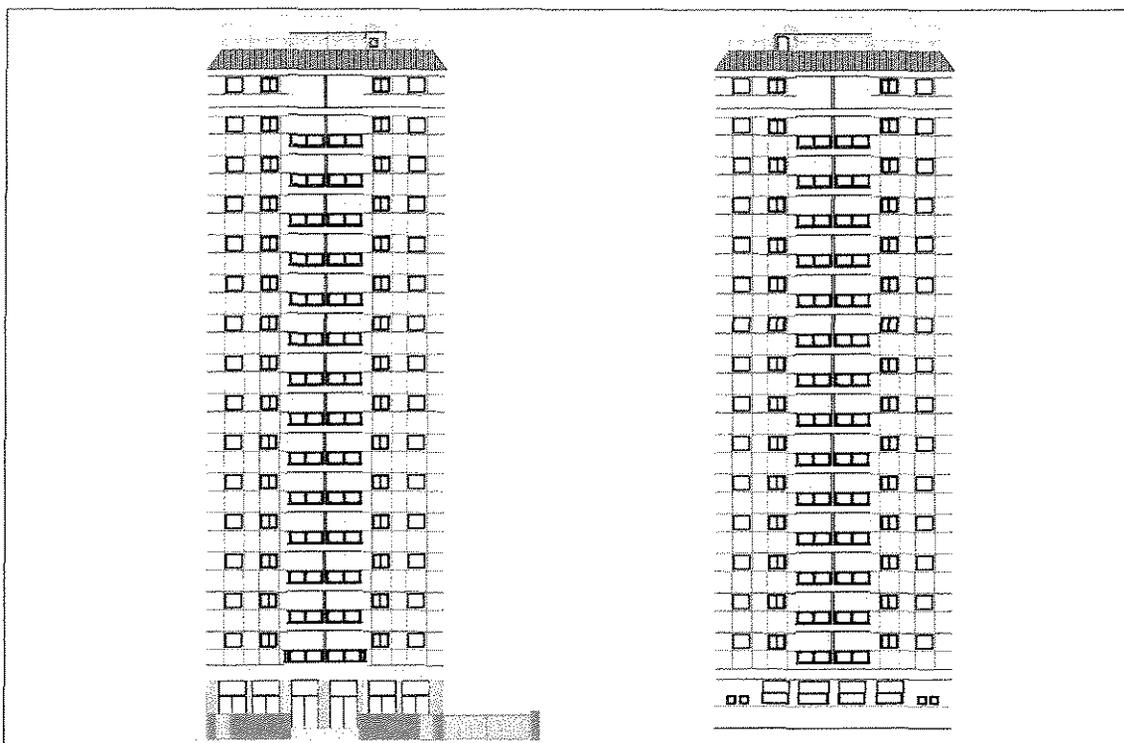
Elevações da Fachada Frontal e dos Fundos do Prédio
